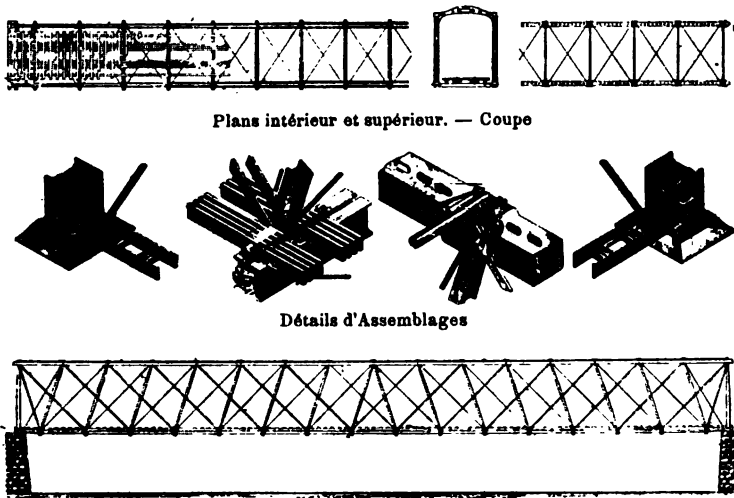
à 66. — Pont sur la Rensselaer and Saratoga R. R. Détails.
